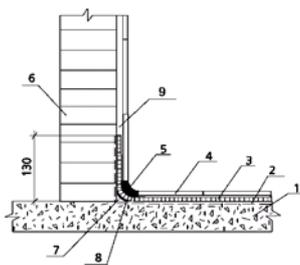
Устройство гидроизоляции ванных комнат и санузлов.
